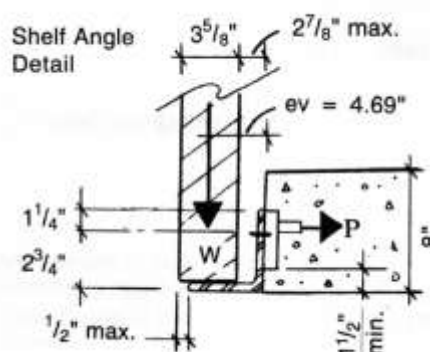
г. Деталь опирания лицевого слоя на стальной уголок (к узлу 3) /1.3/.
